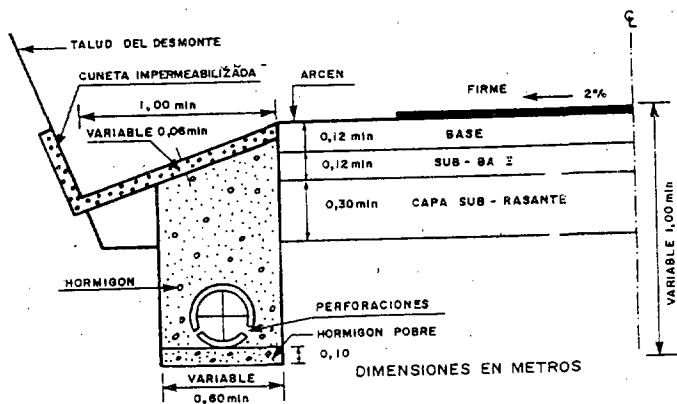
Sección transversal de un dren longitudinal de zanja.
